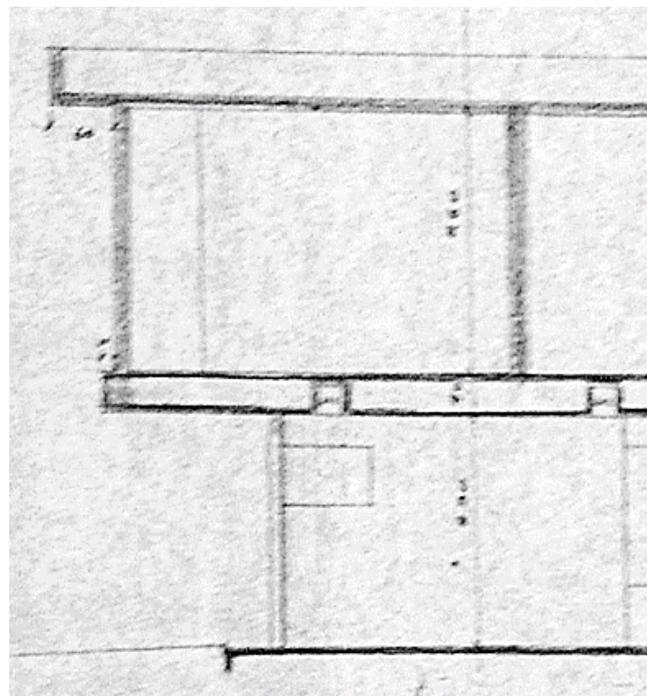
Cortes do projeto original prevendo laje dupla no piso e viga invertida na estrutura de cobertura.
